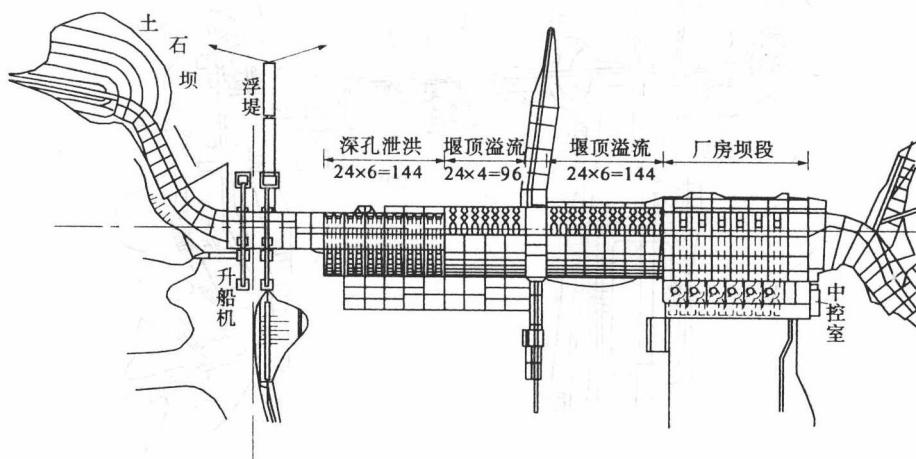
丹江口(坝后式)水电站枢纽平面布置图 (单位:m)
